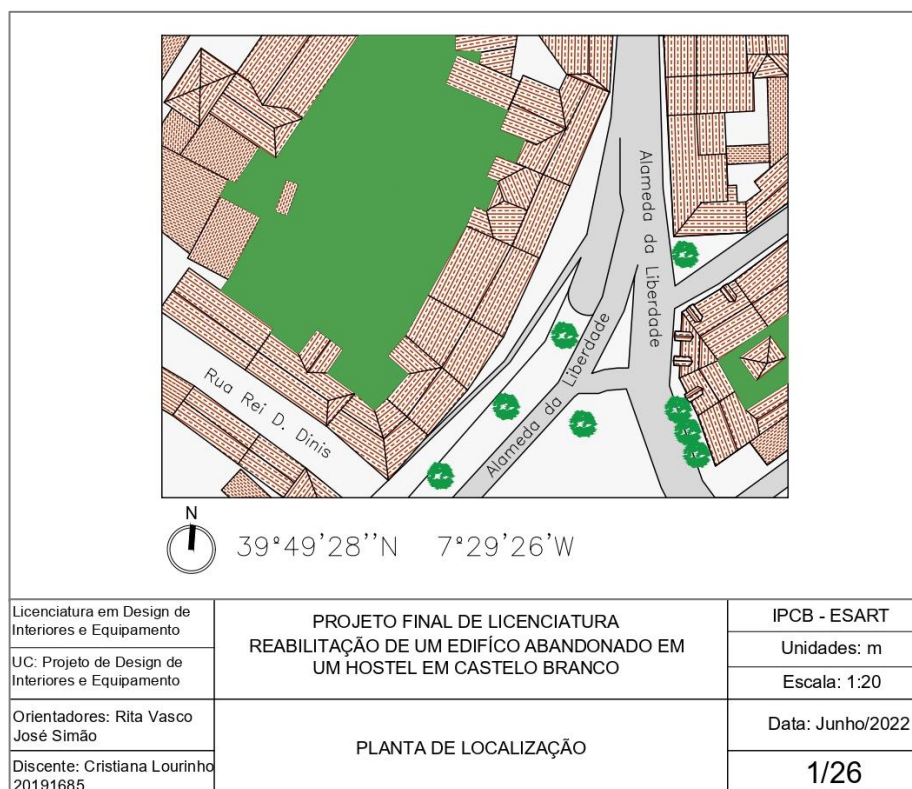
Planta de localização. Fonte: Cristiana Lourinho
